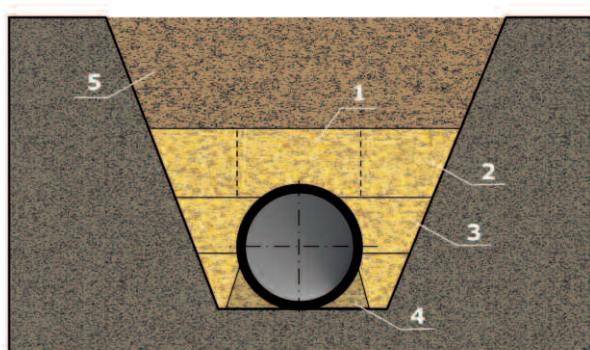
Схема уплотнения грунта при засыпке траншеи: 1 – зона над трубопроводом, где уплотнение грунта запрещается; 2, 3 – слой грунта, уплотненного ручными механизмами; 4 – слой грунта, уплотненного ручным немеханизированным инструментом; 5 – слой грунта, уплотненные механическими трамбовками
